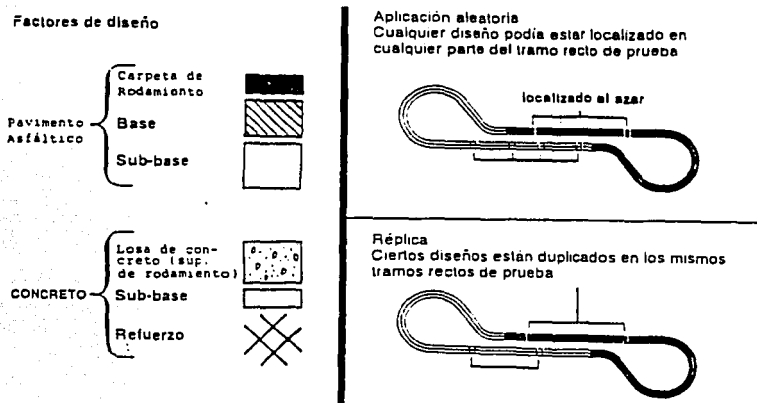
2 FACTORES DE DISEÑO Y DISTRIBUCION DE SECCIONES DE PRUEBA.
